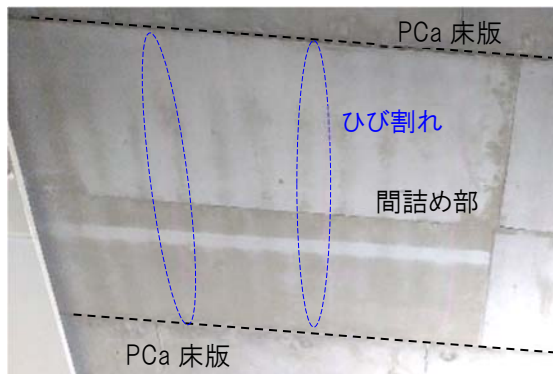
間詰めコンクリート部の拘束ひび割れ
